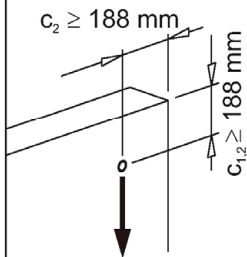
Einbausituation Wandfläche - Querbeanspruchung ohne Betonkantenbruch, ohne Rückhängebewehrung
